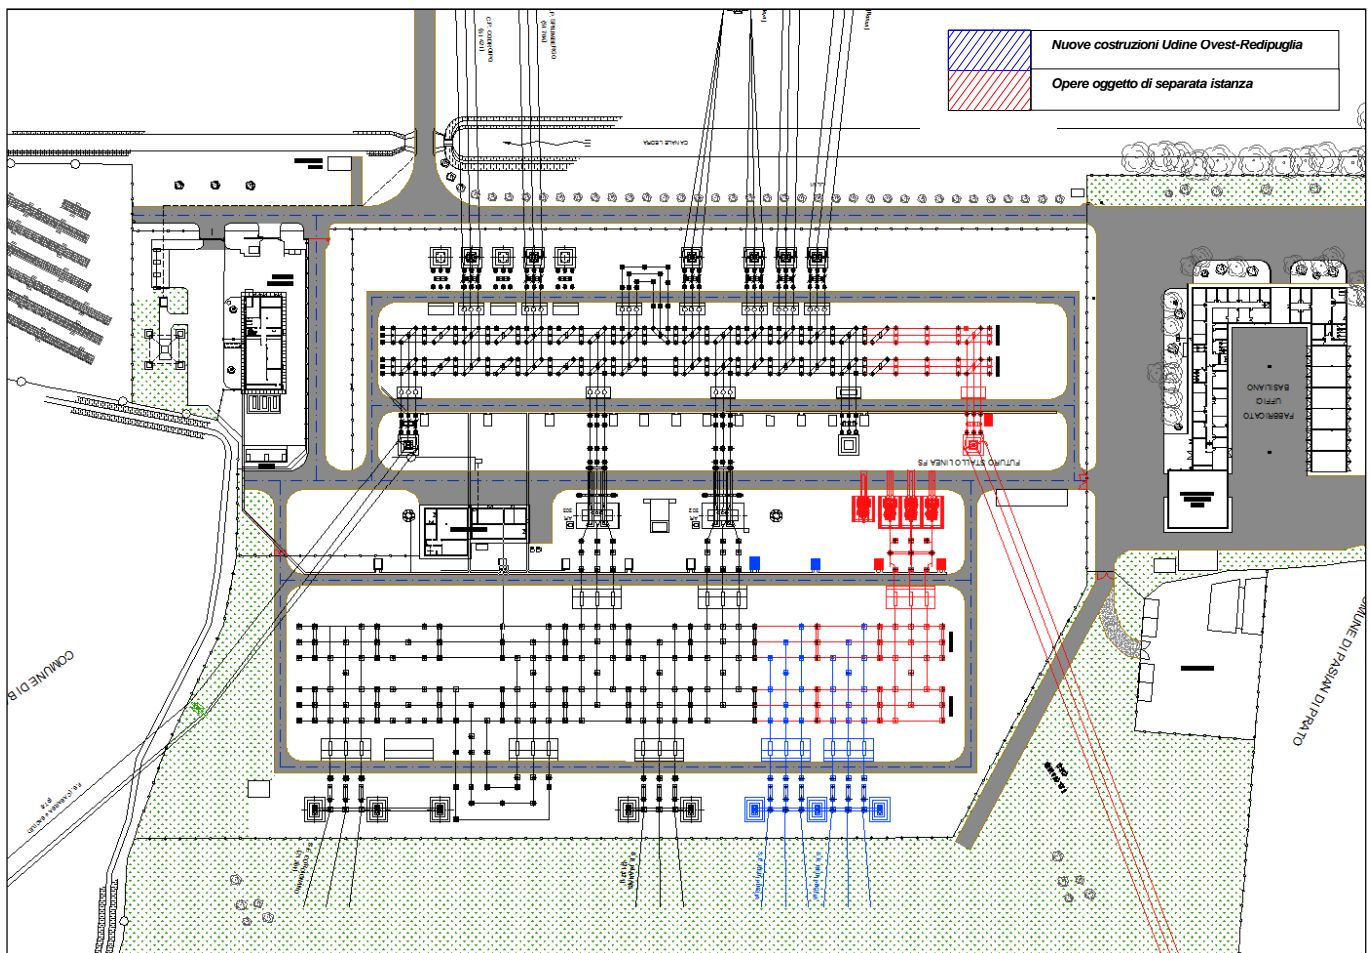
Planimetria elettromeccanica della S.E. 380/132 kV di Udine Ovest
